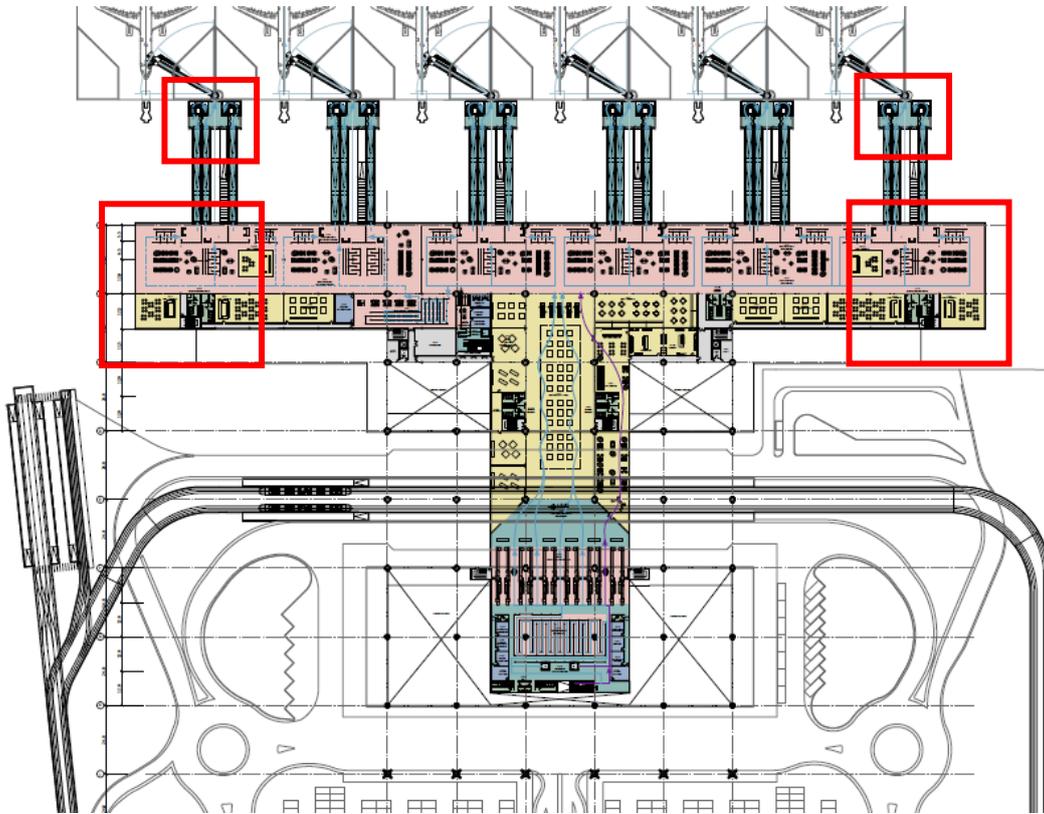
| Planimetria Piano Primo Terminal Anno 2035
